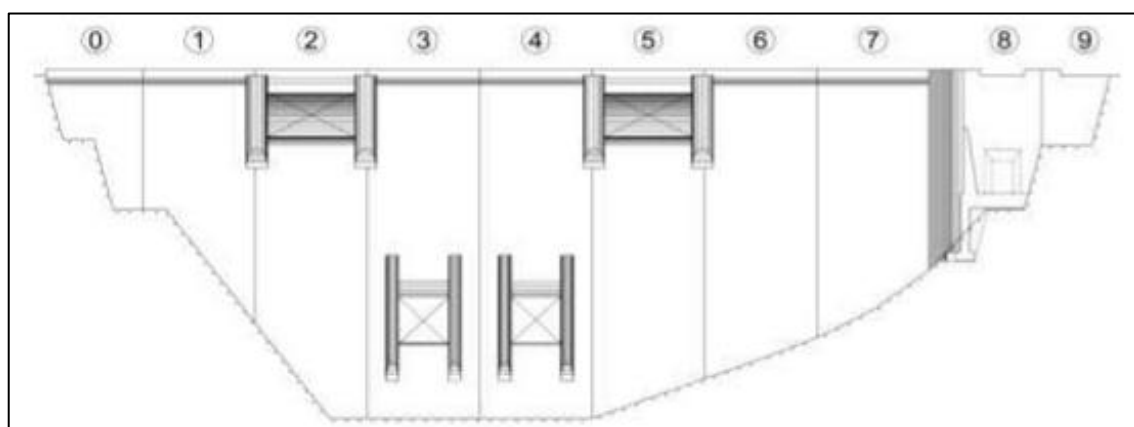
Vista en planta de la presa Toachi, subdivisión de bloques
